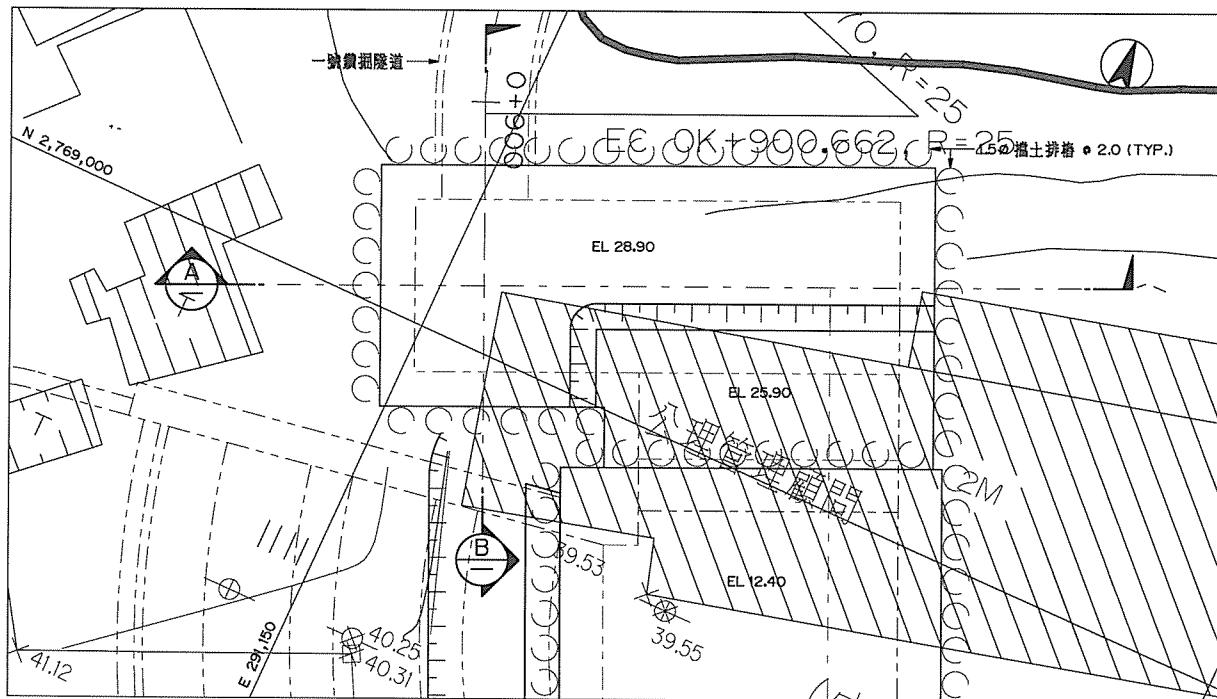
一號鑽掘隧道南洞口平面圖
